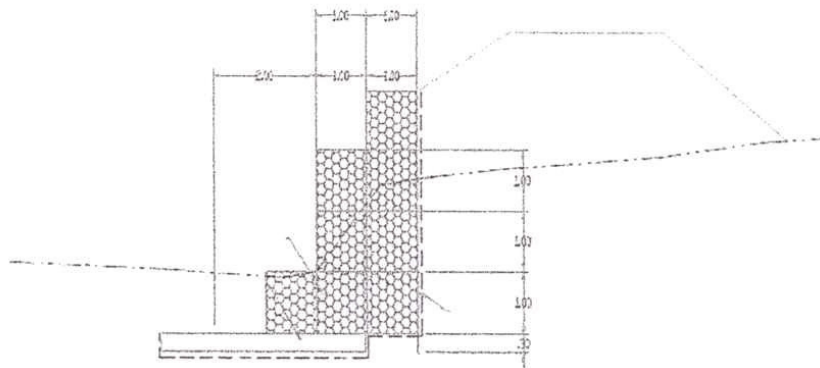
Sección típica propuesta para la construcción de Dique en La Mari
